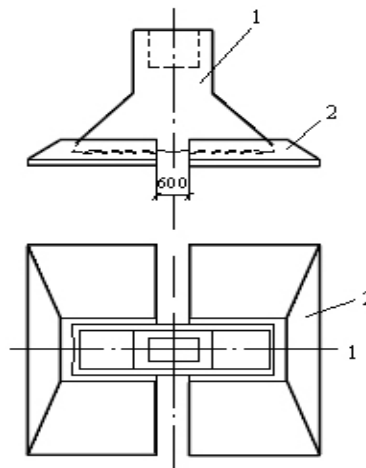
Сборный составной фундамент: 1 – подколонник; 2 – плита
